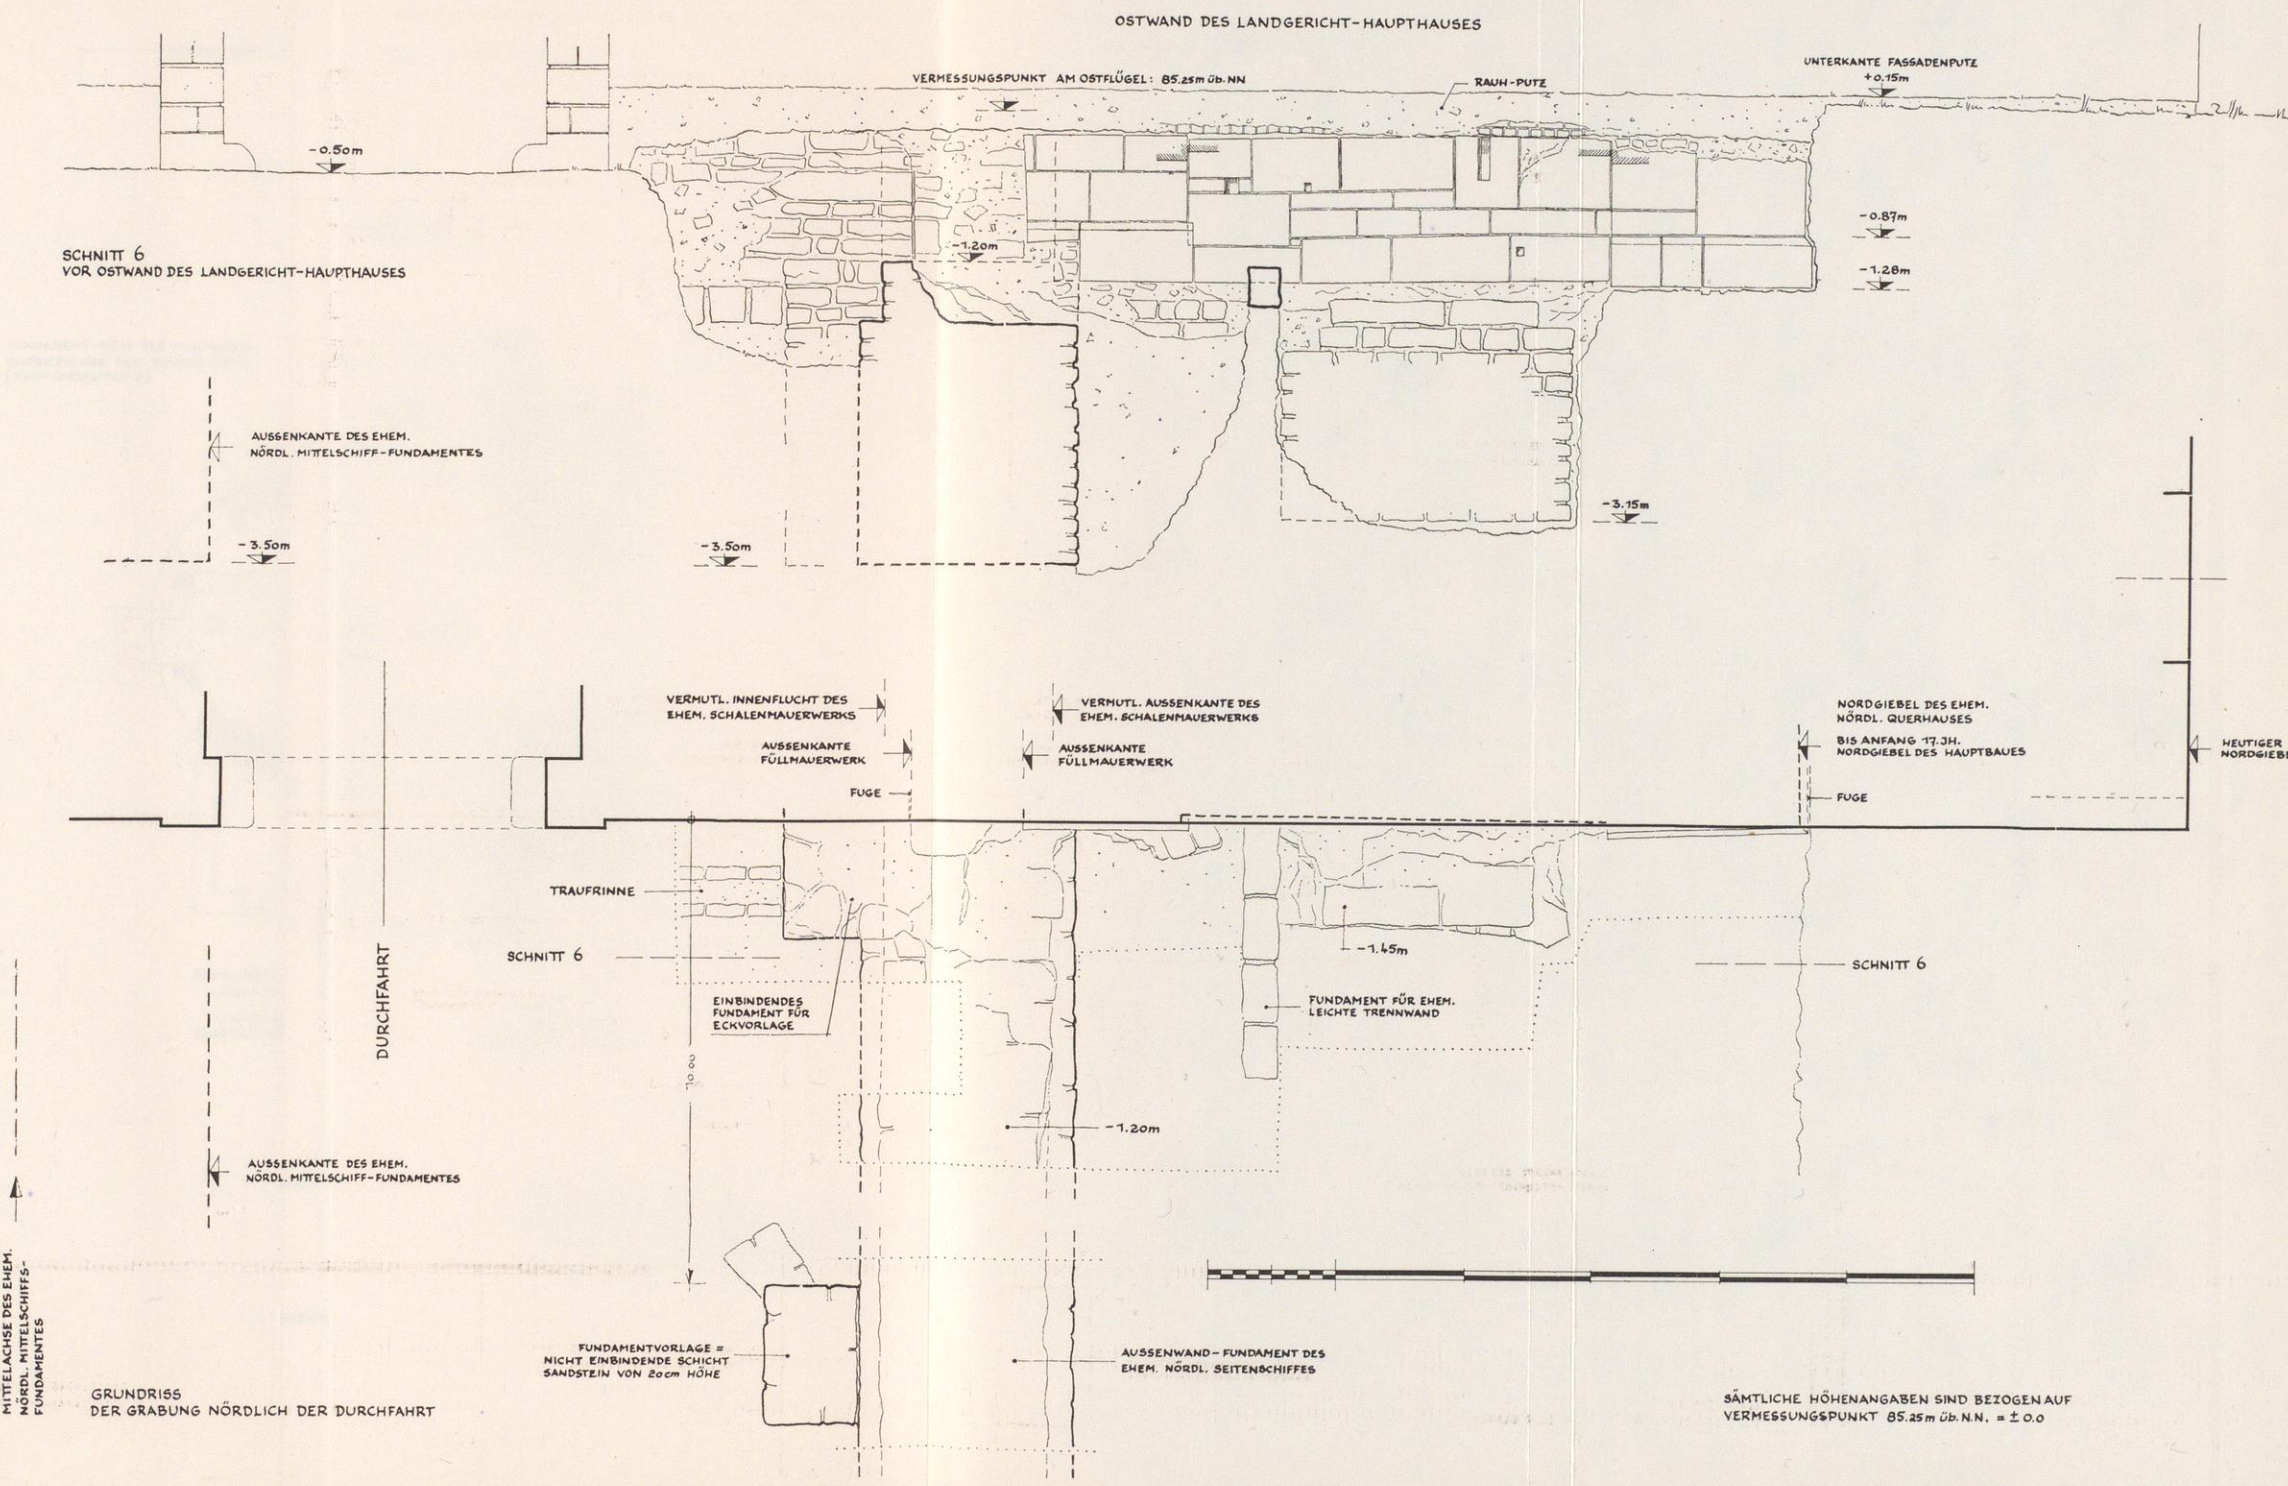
Grundriss des Gebäudes, das die Fundamente des Dönnhofs bildet.
